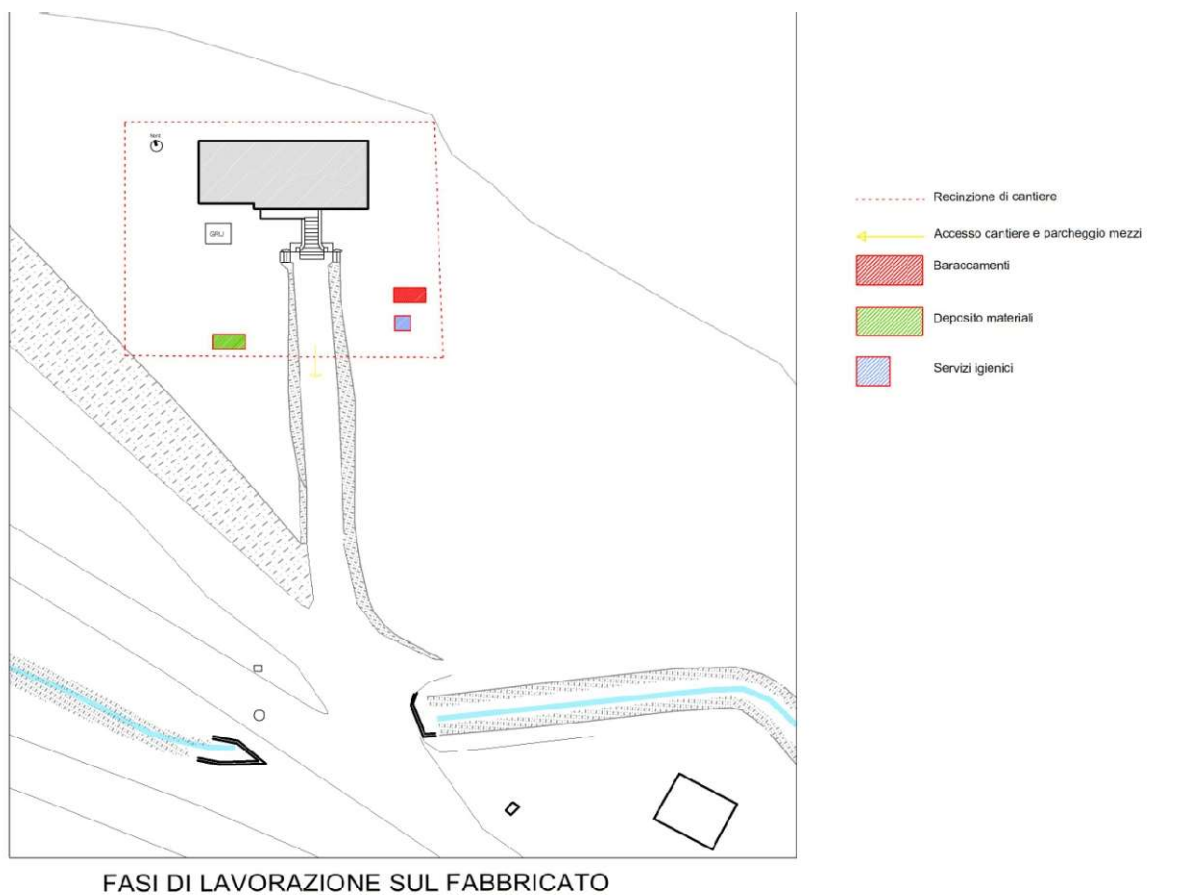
Layout di cantiere nelle fasi di lavorazione previste
